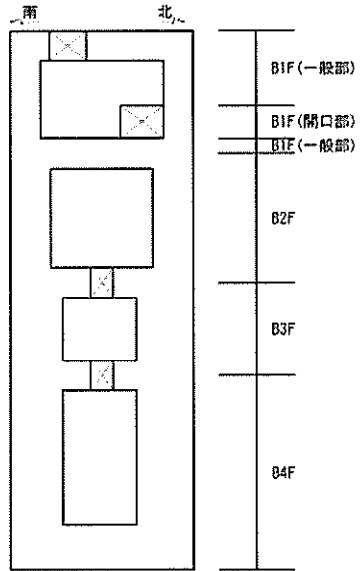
(3) 概略配筋図 (南北方向断面)
